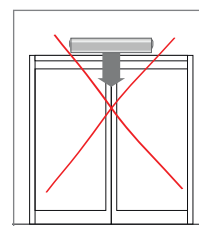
Der Luftstrom muss die gesamte Öffnung abdecken.
